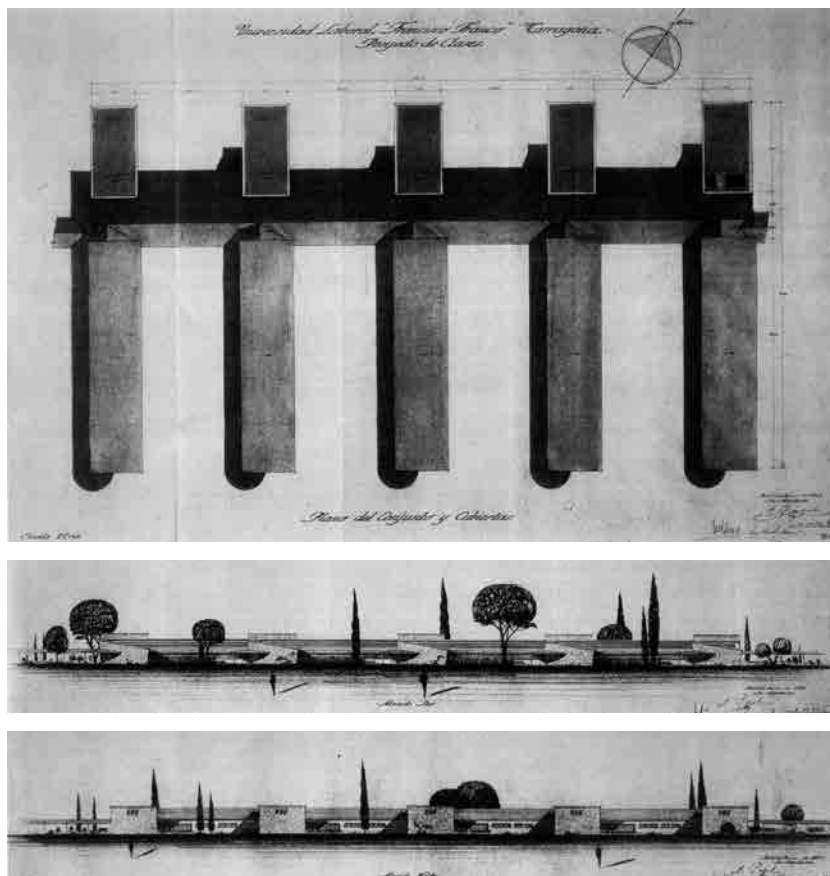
, Fig. 42 y Fig. 43 Grupo escolar. Planta de cubiertas (arriba), alzado de la fachada abierta al mar (centro) y alzado de la fachada abierta a la explanada central (abajo).
